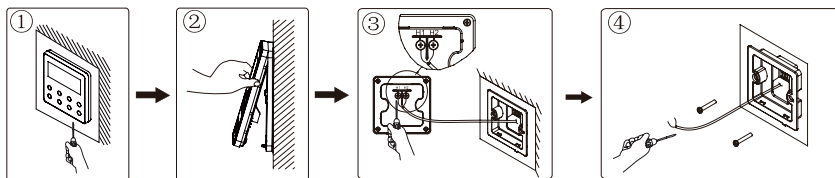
Esboço esquemático da desmontagem do controlador por cabo
